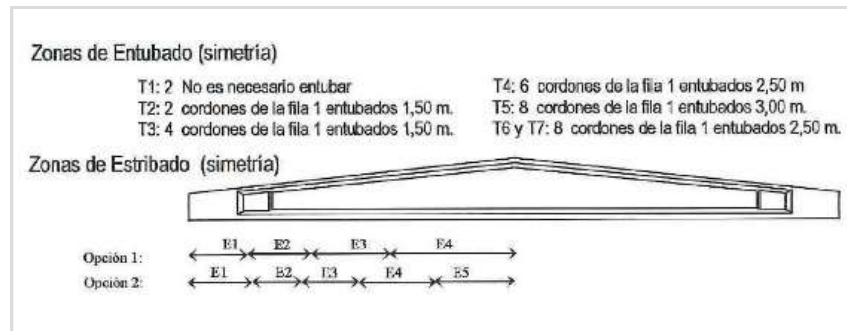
Geometría, corte, armaduras y estribado de la viga delta utilizada
